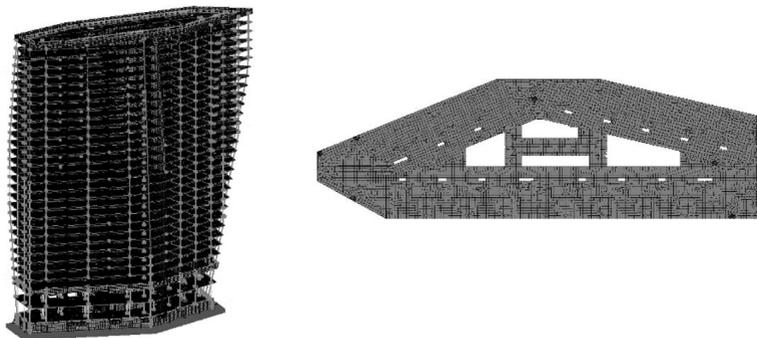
Общая расчетная схема и наиболее нагруженная плита, фрагментированная на горизонтальную плоскость
